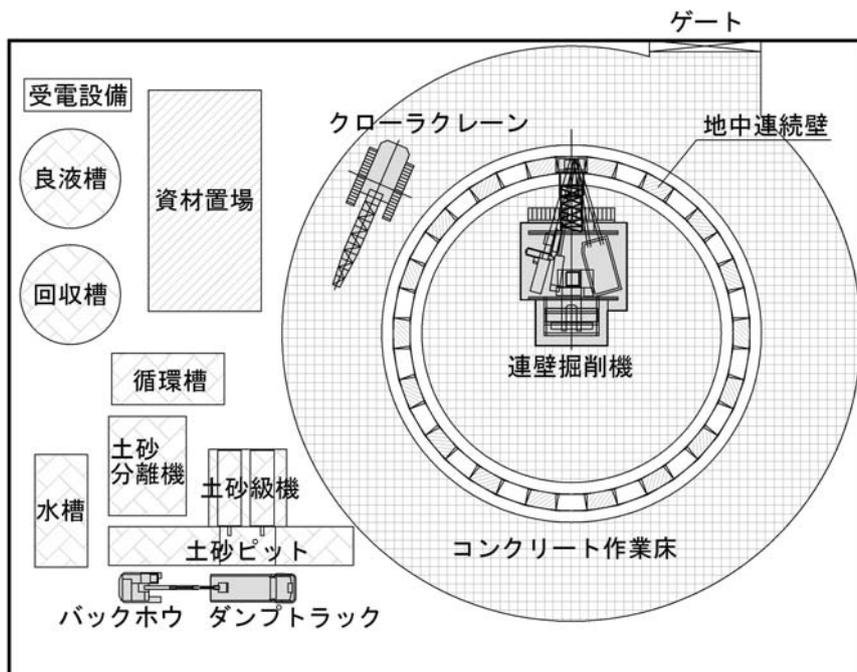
非常口の施工ヤードの概要 (RC地中連続壁工法による非常口施工時)
